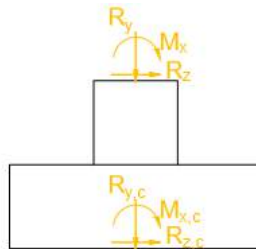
Reacciones en la base de la cimentación. Plano YZ.
